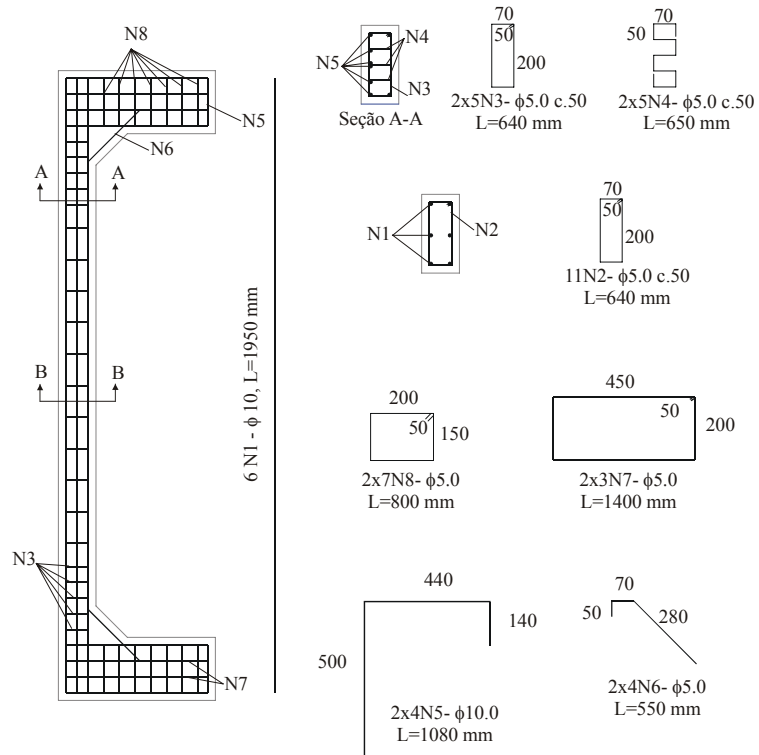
Detalhamento de armaduras do grupo PCA6
